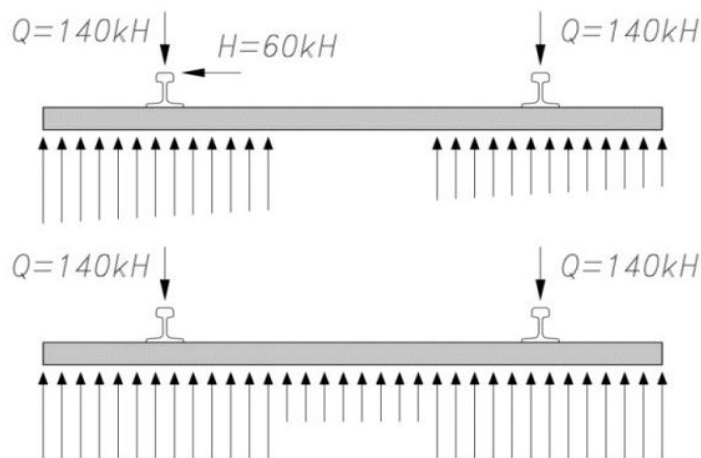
Расчетные схемы нагрузки и опирания на балласт
